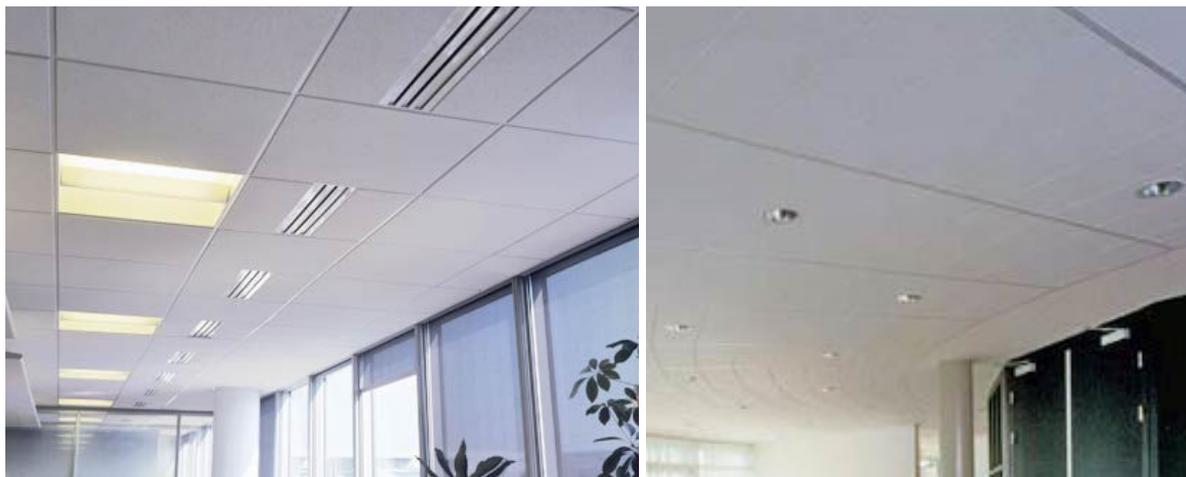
Placas com dimensões de 625 x 625 mm e 1250 x 625 mm.
